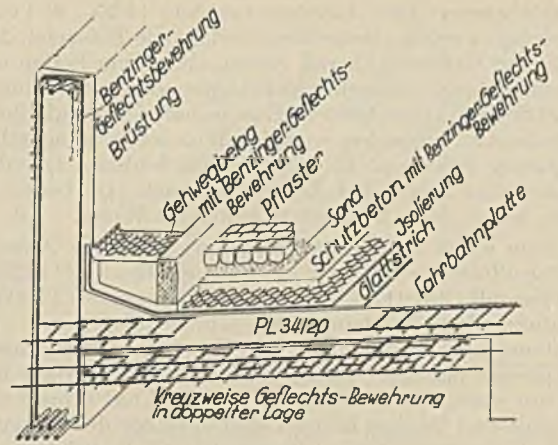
Bewehrung einer Reichsautobahn-Trogbrücke mit Benzinger-Geflecht.
